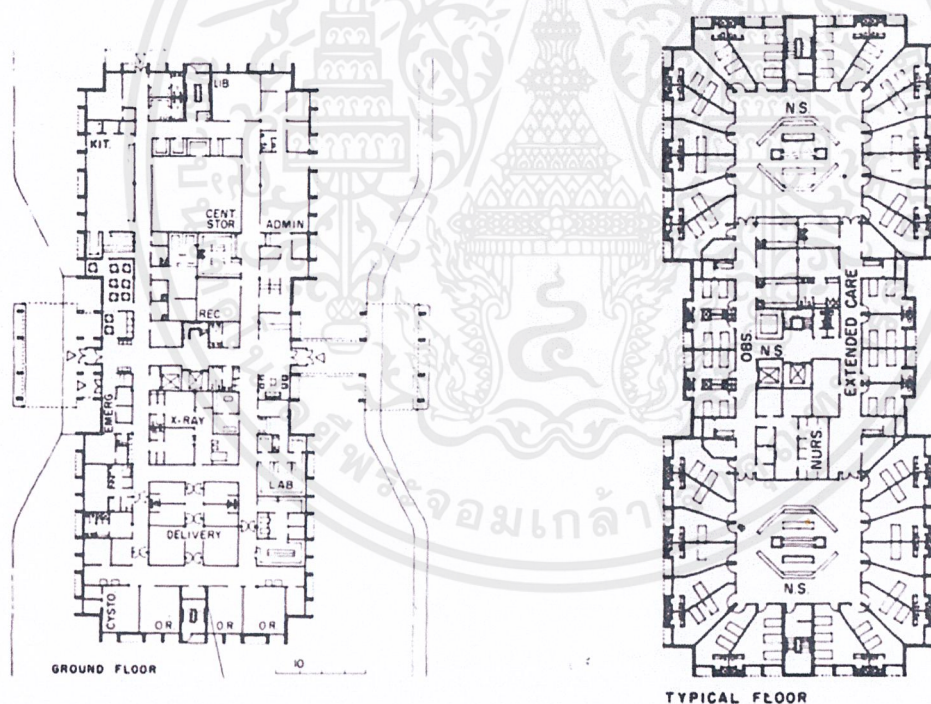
ภาพแสดงแผนผังชั้น 3
